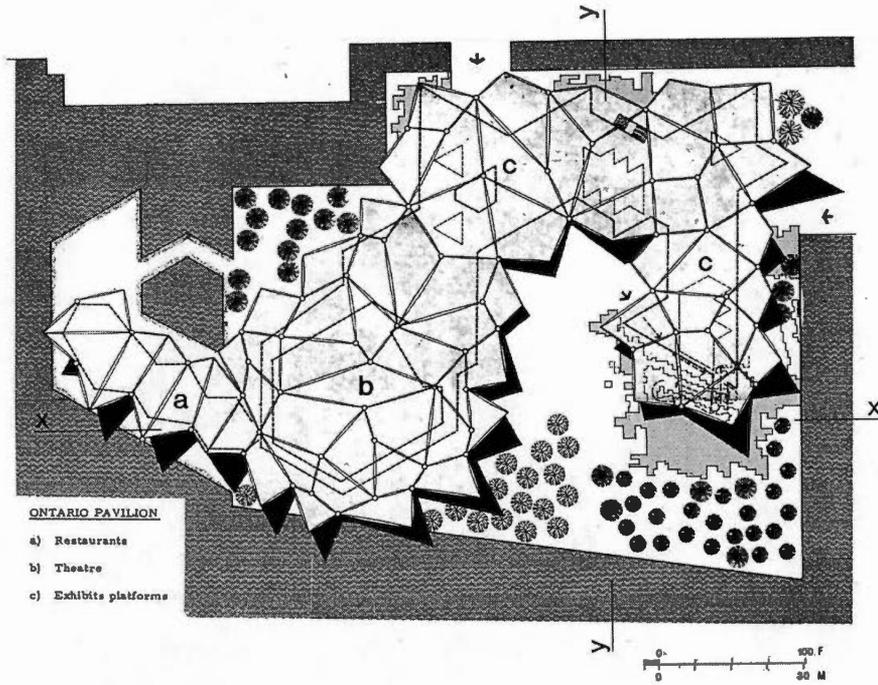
Plan du site. Pavillon de l'Ontario
